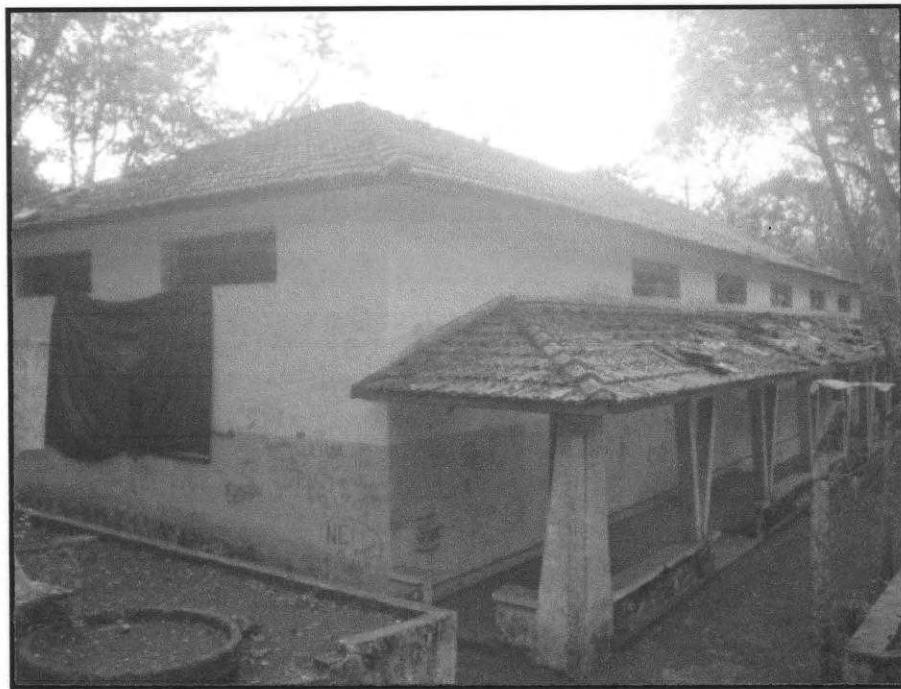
Vista externa das instalações em mau estado de conservação. (Fonte: Folha de Palmital).
